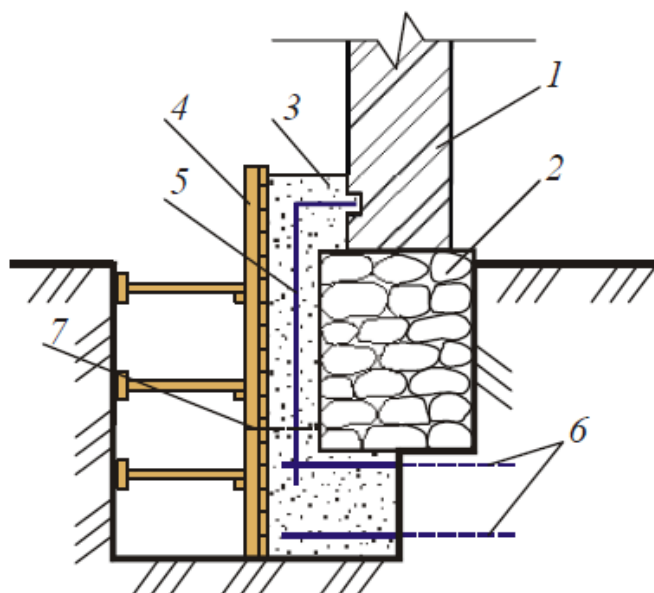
Углубление подошвы фундамента без разгрузки.
